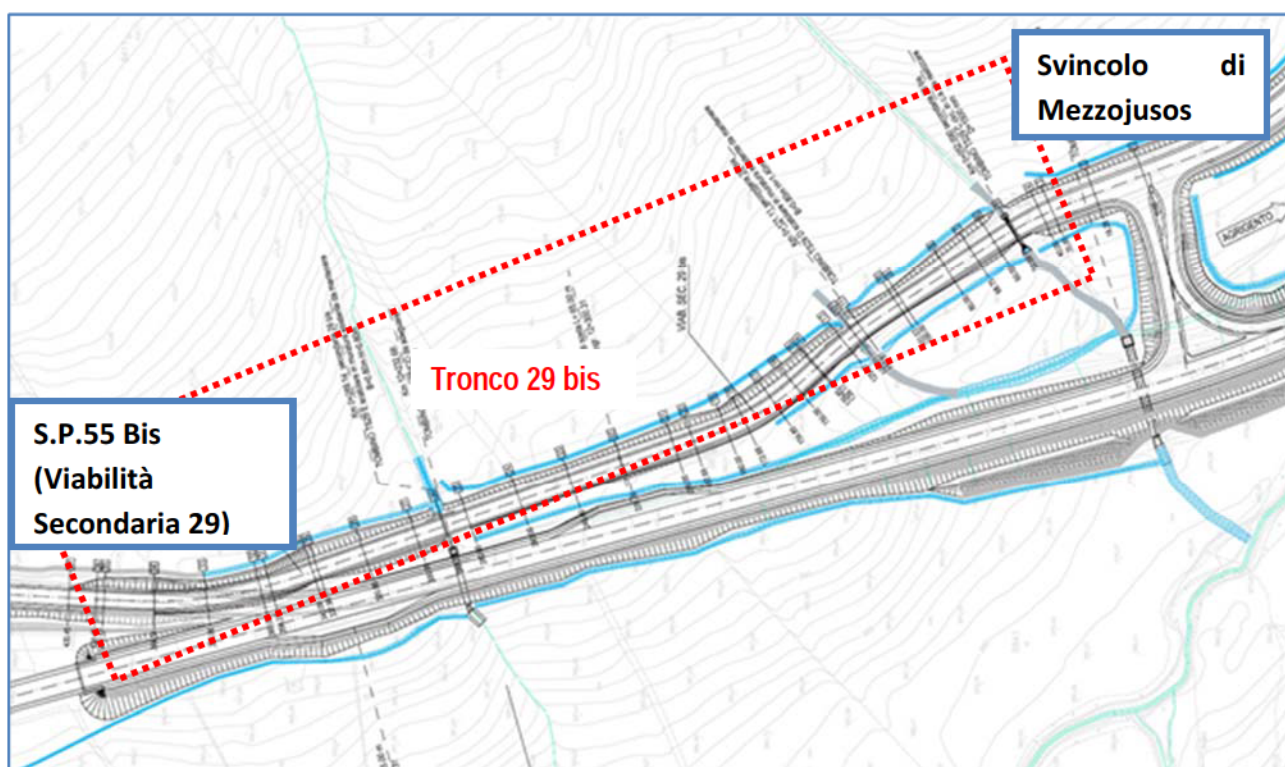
Stralcio planimetrico Tronco 29 Bis.
